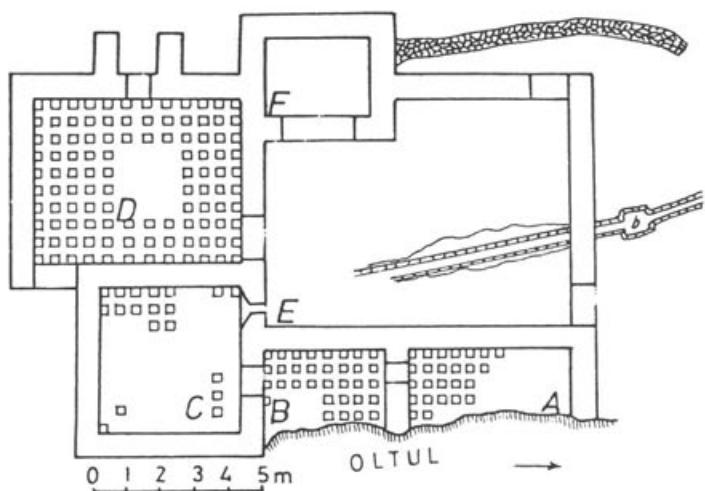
Bivolari, Plan des Bades (nach D. Tudor).
